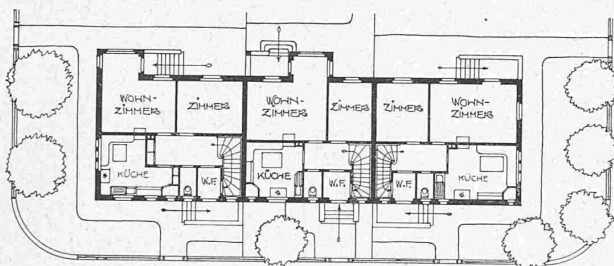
und 44. Grundrisse vom Erdgeschoss und Obergeschoss von Baublock 4. — Masstab 1:400.
